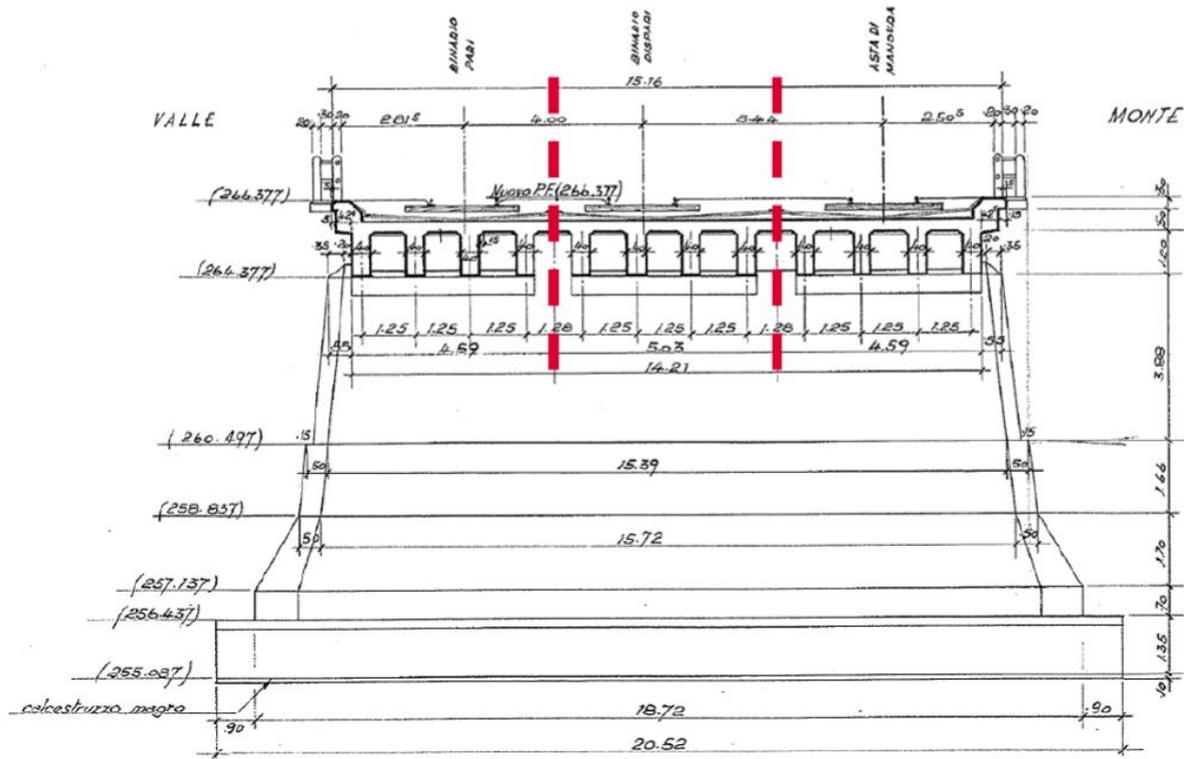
Sezione Trasversale Ponte sull'Isarco
